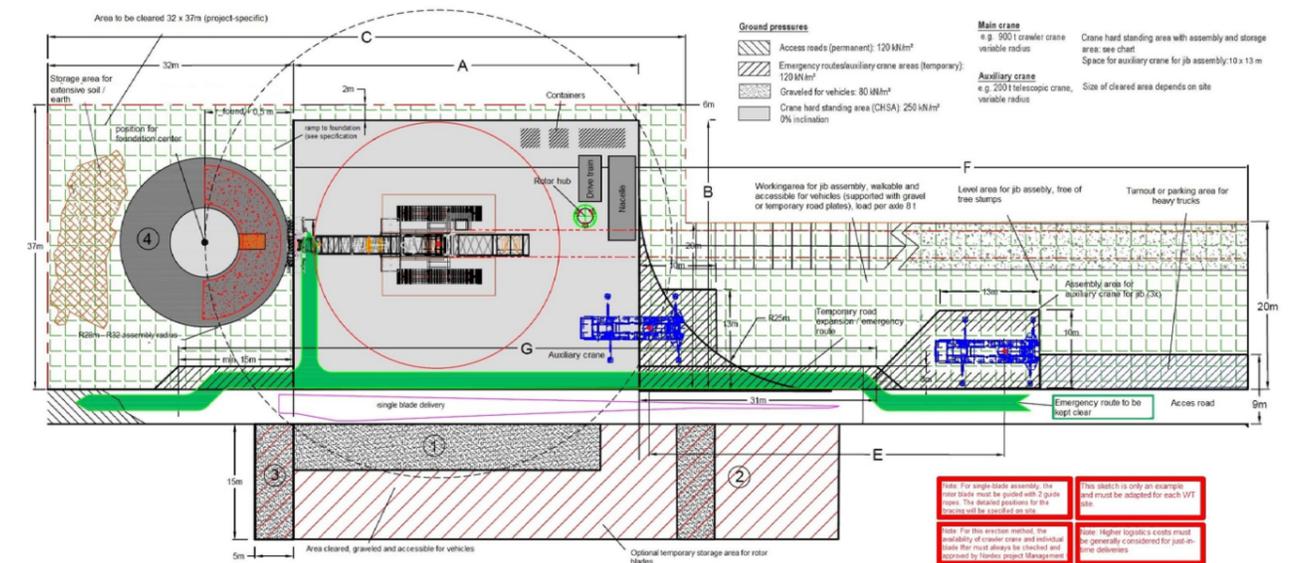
Plateforme de montage avec grue optimisée pour les zones sur les terrains ouverts (assemblage à une seule pale) pour les éoliennes d'une hauteur de moyeu jusqu'à 170m
